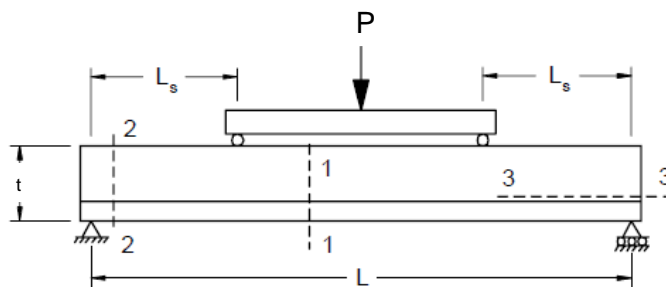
Mecanismos principales de falla de las losas con placa colaborante.
